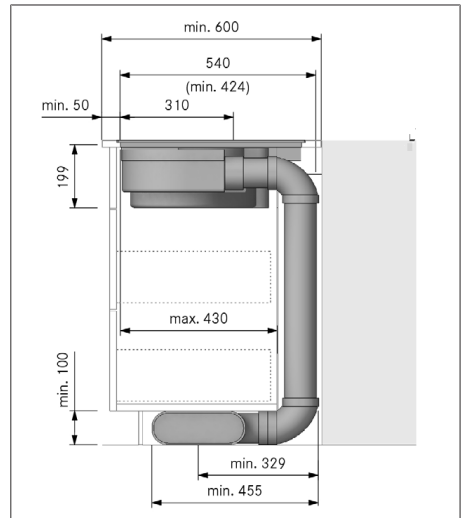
Monteringsdimensjoner ved uttrekking, benkeplatedybde 600 mm
